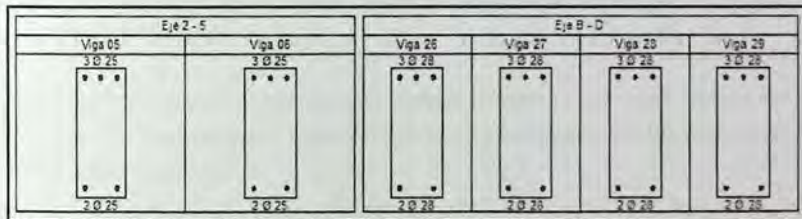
Distribución de refuerzo a flexión en vigas, ejes principales de estructura VI (Nivel 1-3).
